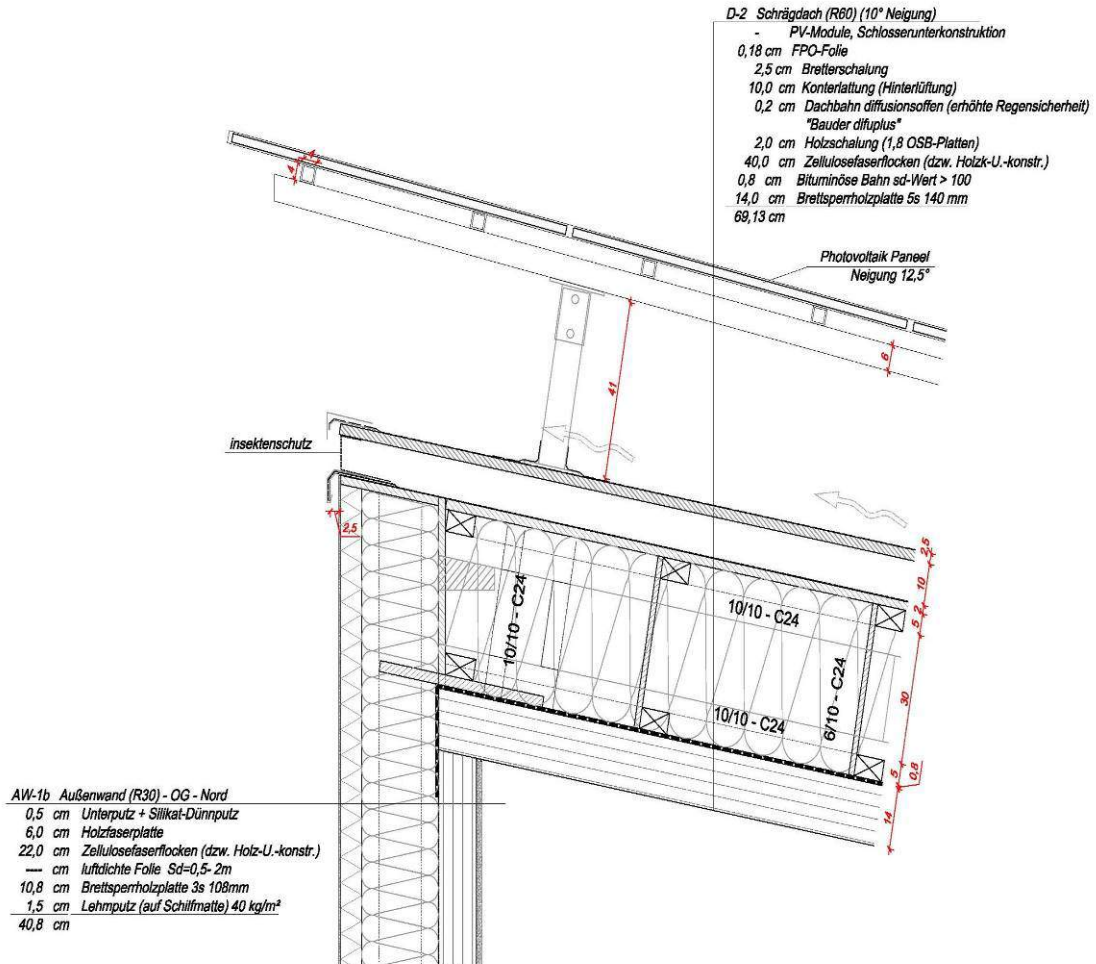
Firstdetail Büro – Holzkonstruktion gedämmt mit Zellstoff
